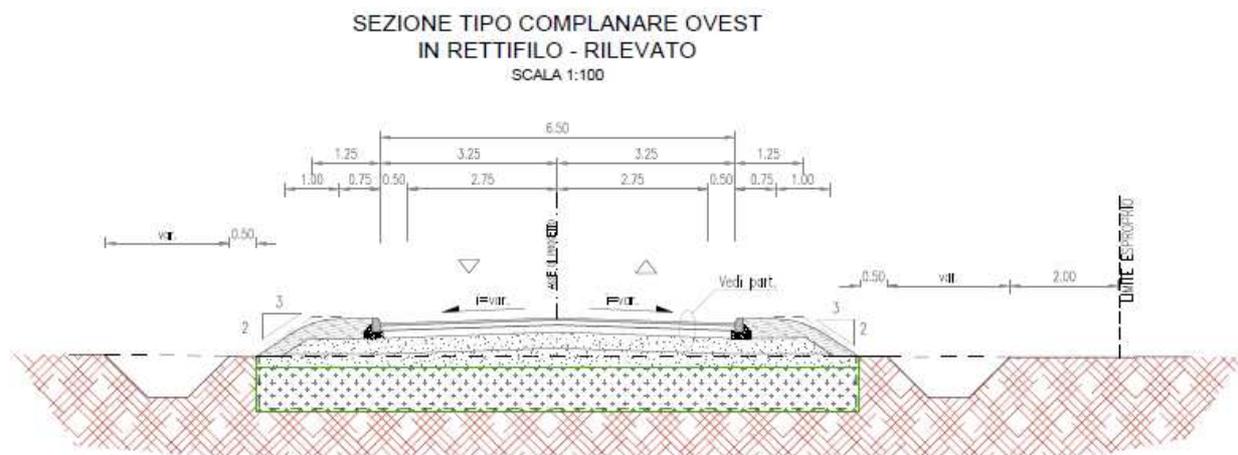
Sezione Tipo Complanare Ovest in rettifilo
